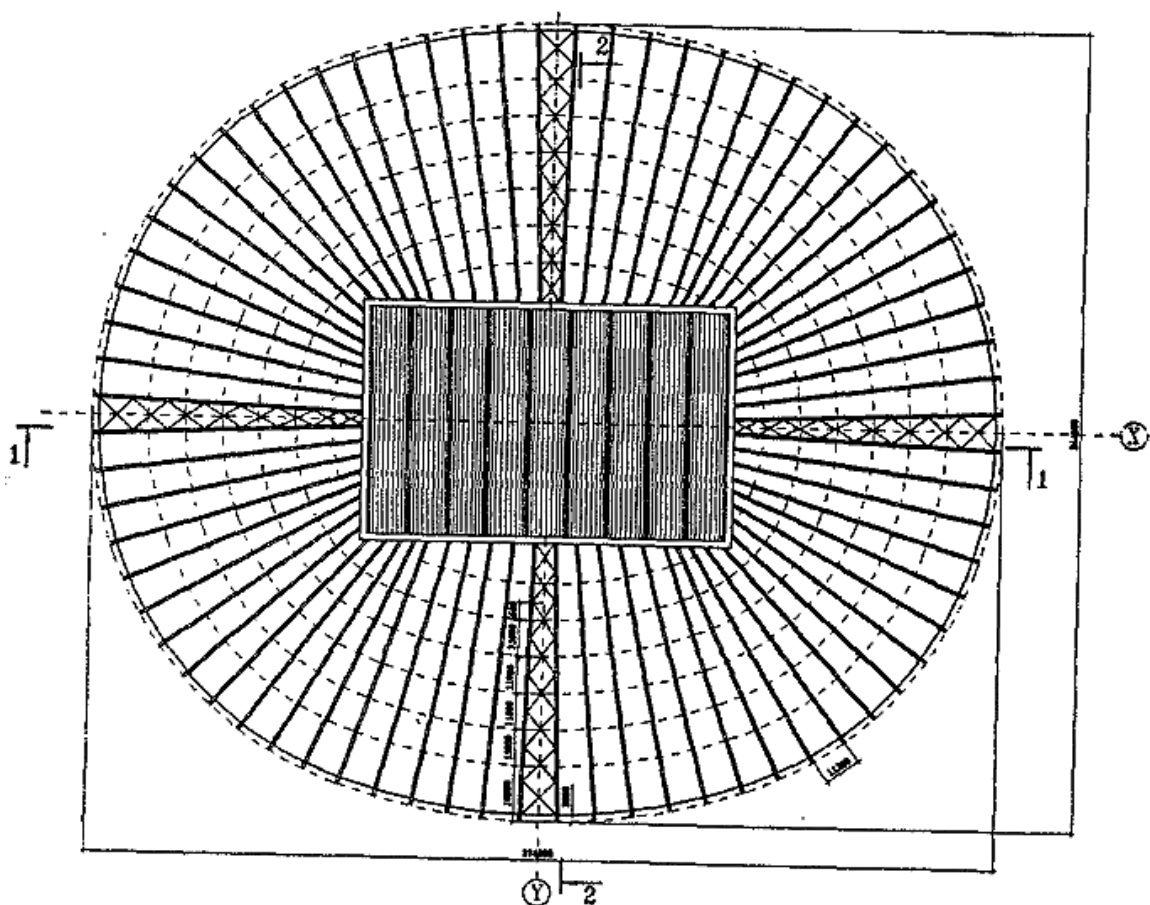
План металлоконструкций подвешенного светопрозрачного покрытия стадиона «Спартак»
